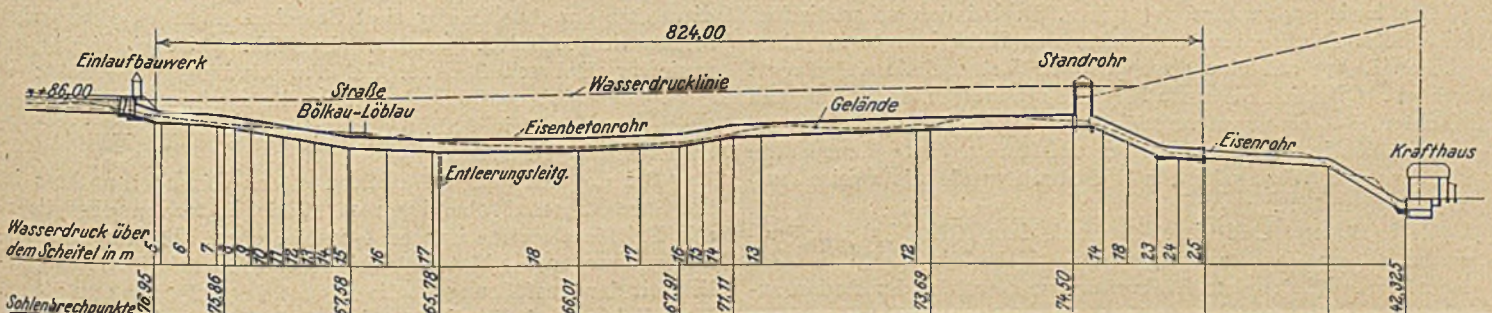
Längsschnitt durch das Eisenbetondruckrohr.
